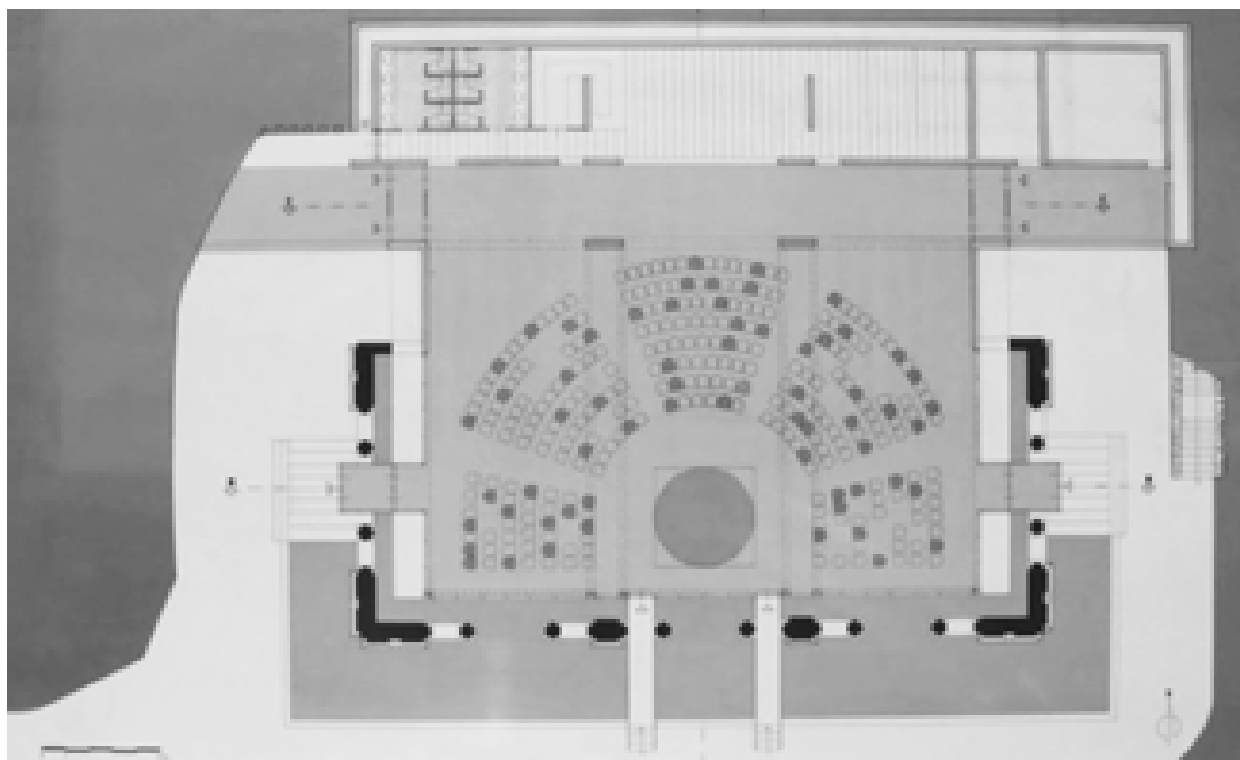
Planimetria del piano terra, stato futuro - Progetto del 15/07/1985, agg. del 15/01/1987 (AABS-914)
